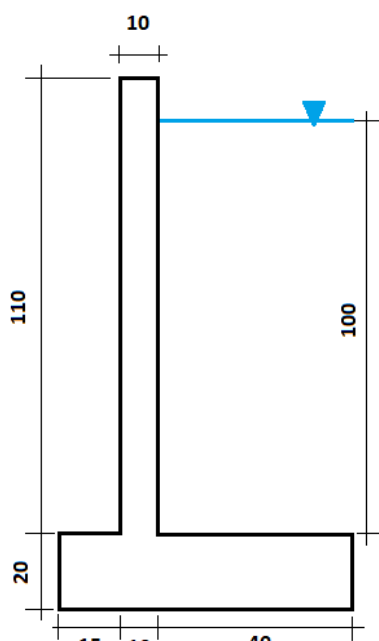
Croquis dels murs de la bassa (cotes en cm)
